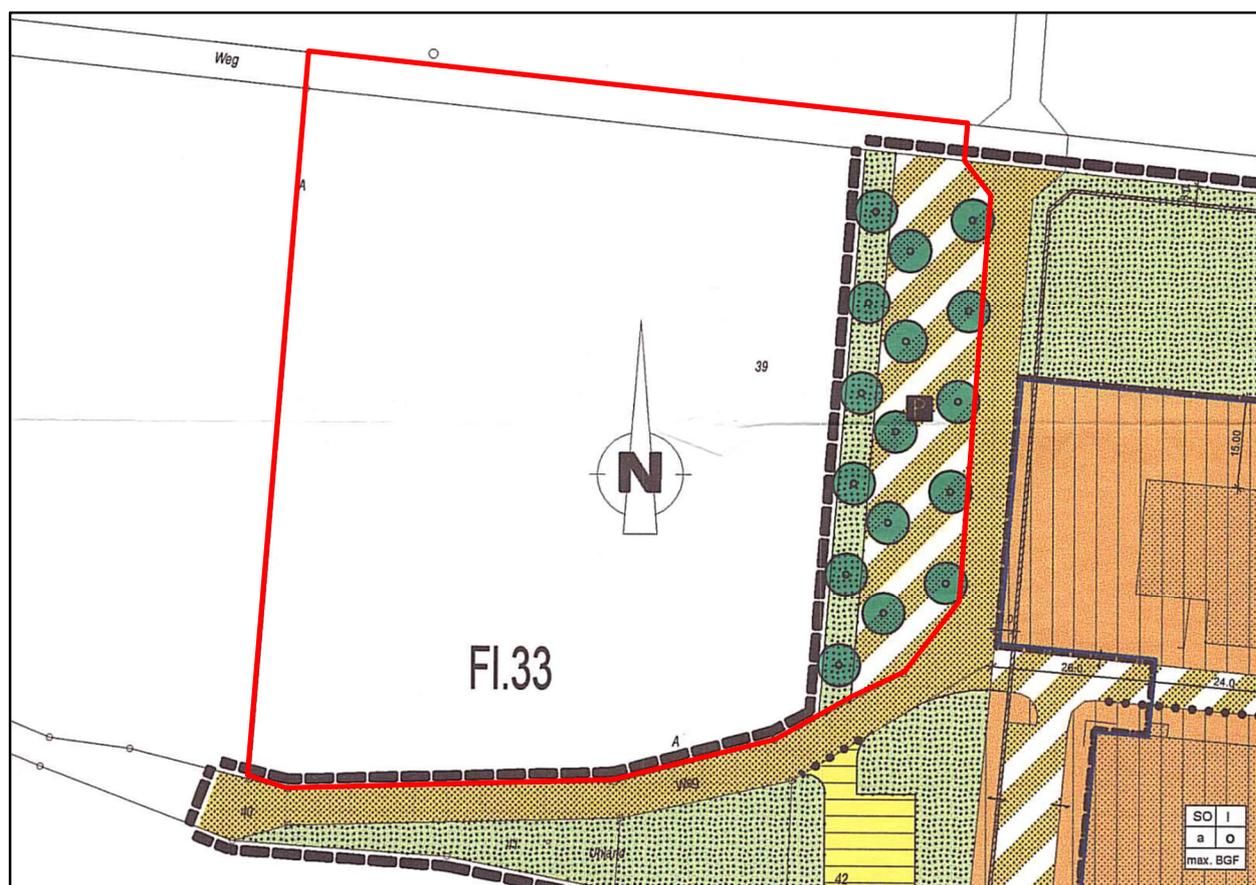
Ausschnitt aus dem Bebauungsplan „Sondergebiet Krankenhaus Am Mönchberg“
